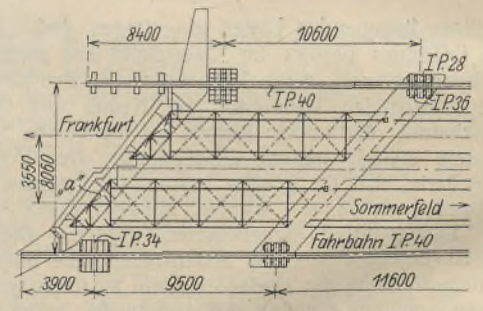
u. b. Lubbesbrücke der Strecke Frankfurt/Oder—Sommerfeld.
